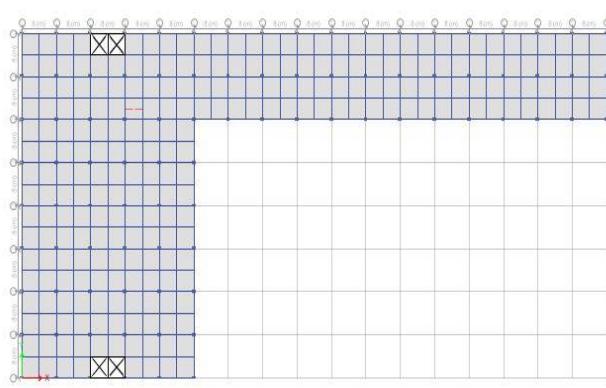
Denah Lantai 7 - Lantai 8 Model B1
